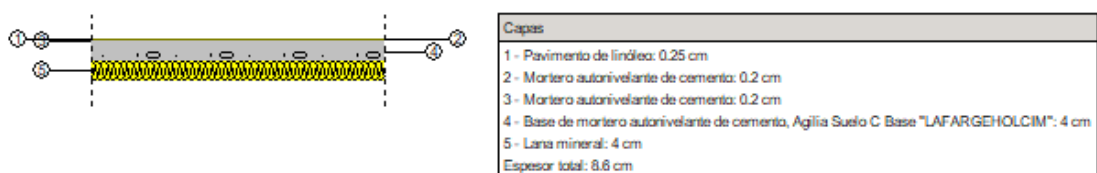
Detalle Pavimento Linóleo. Fuente: Programa CypeMEP
